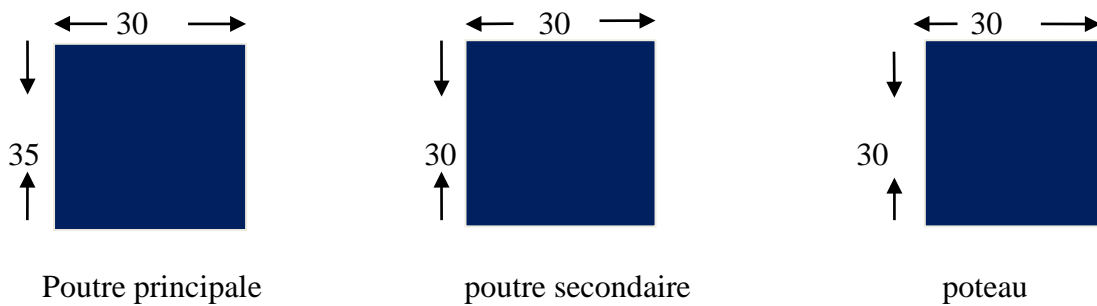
dimensions des sections de béton des poteaux et des poutres
